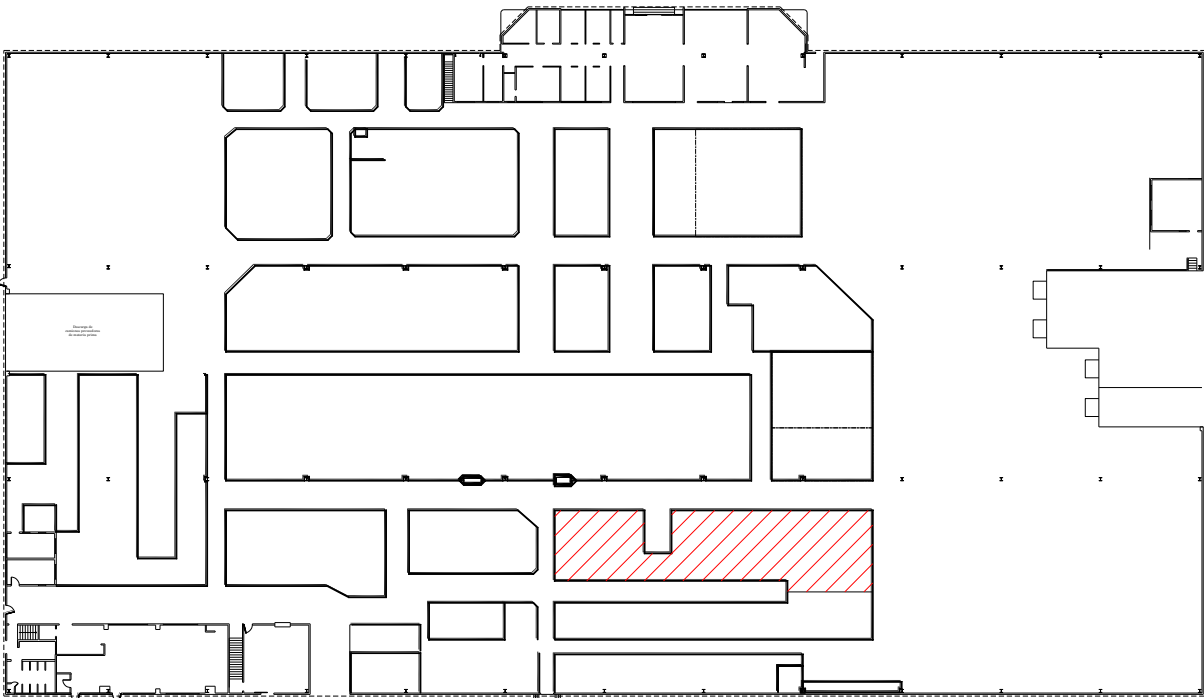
Localización de la Línea Air Flow 1 (AF-1) en la Planta
